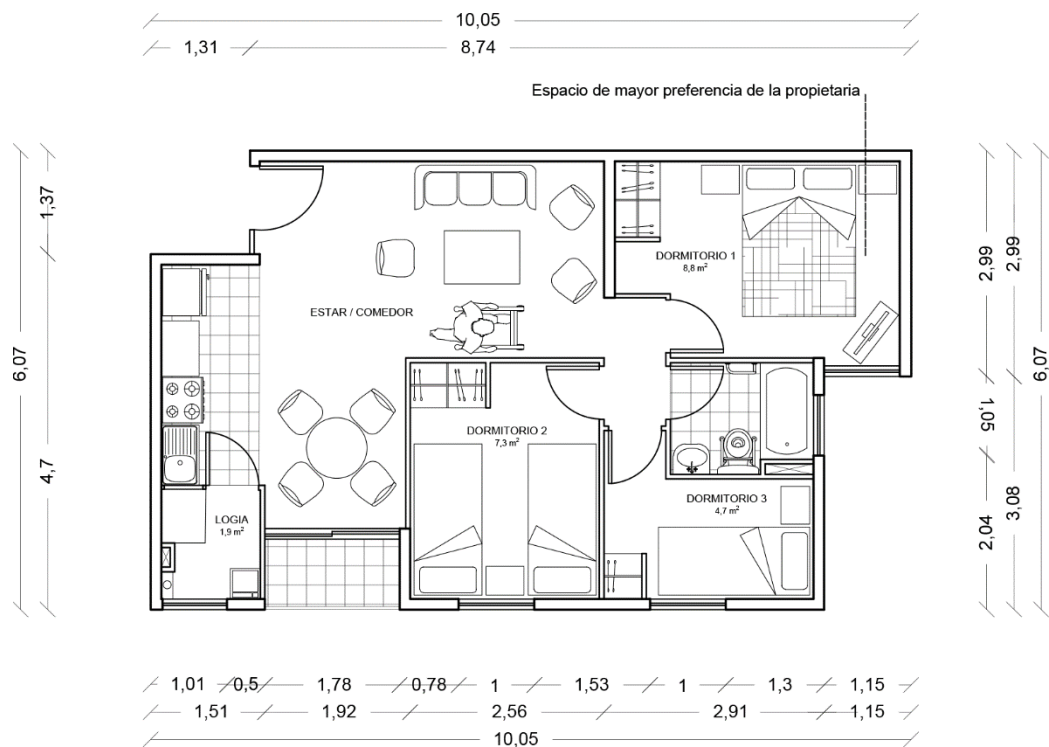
Planta con las adaptaciones a la vivienda de Lucía en Pacífico Rivas 3
